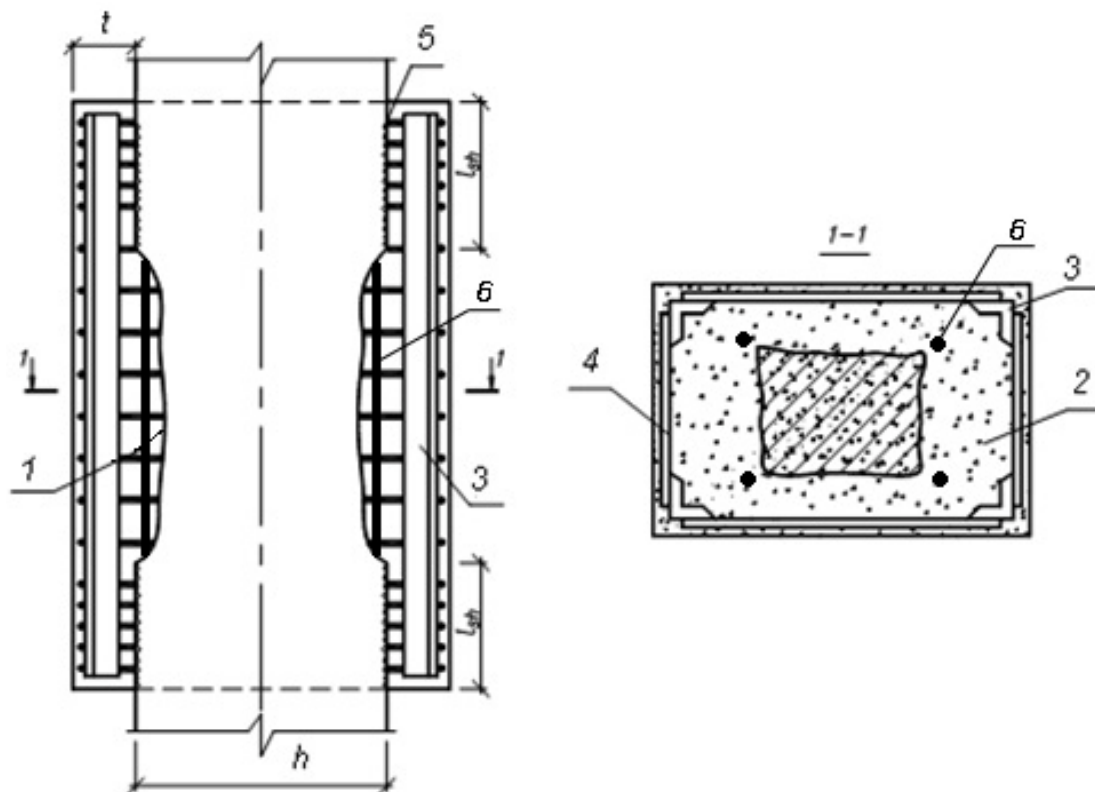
Усиление поврежденного участка колонны местной железобетонной обоймой: 1 – поврежденный участок, 2 – бетон обоймы, 3 – уголок, 4 – соединительные стержни, 5 – насечка поверхности, 6 – оголенная арматура
